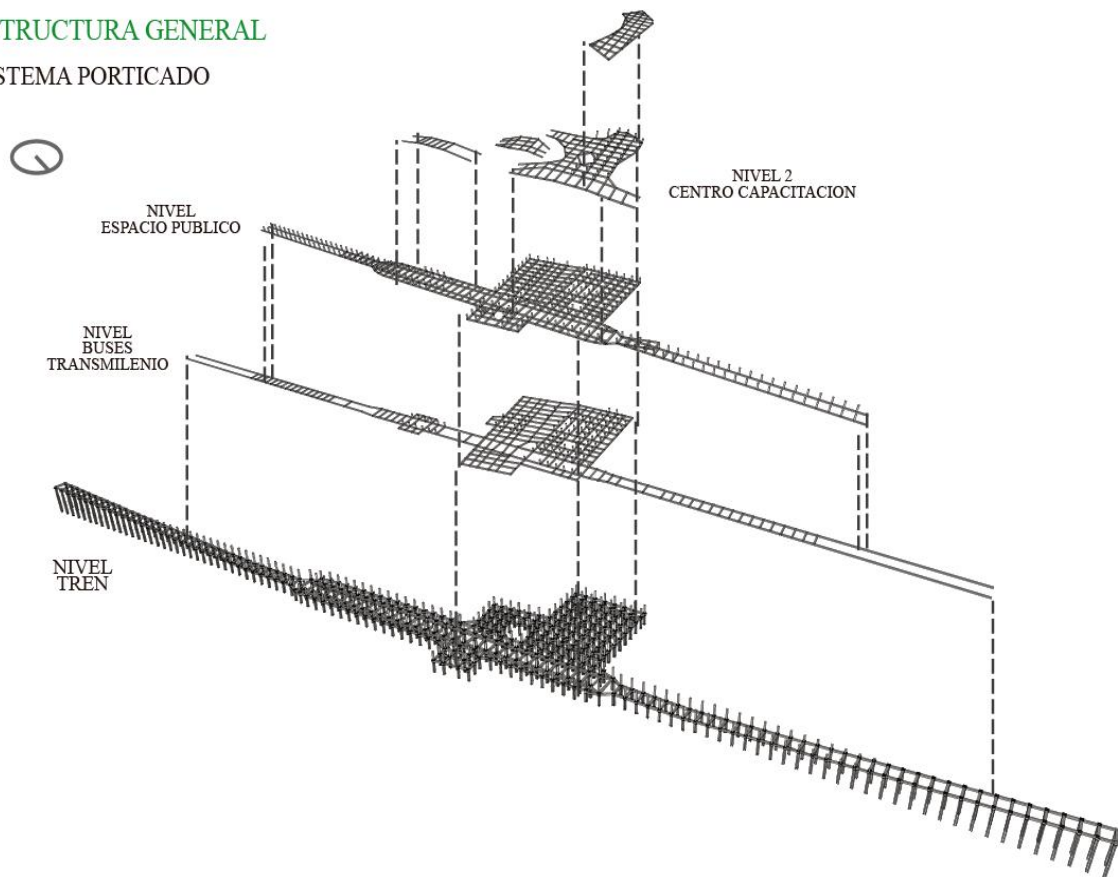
Axonometría Estructura General Proyecto - Elaboración Propia
